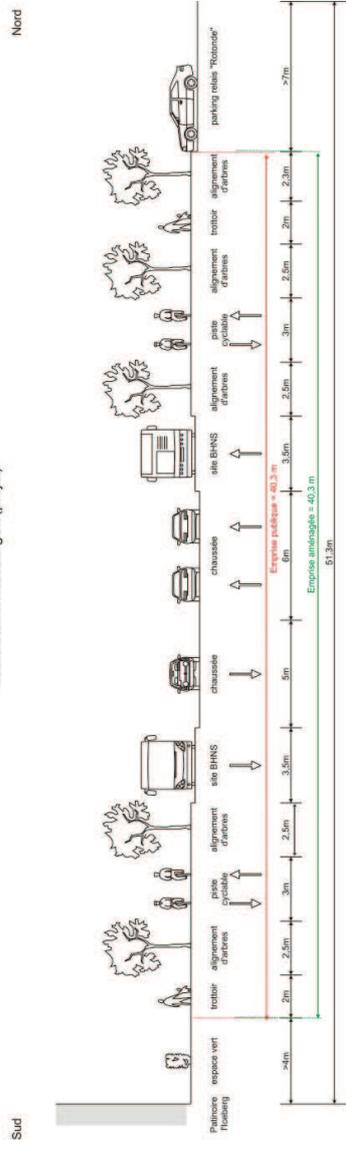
Situation projetée (coupe 31) route d'Oberhausbergen
